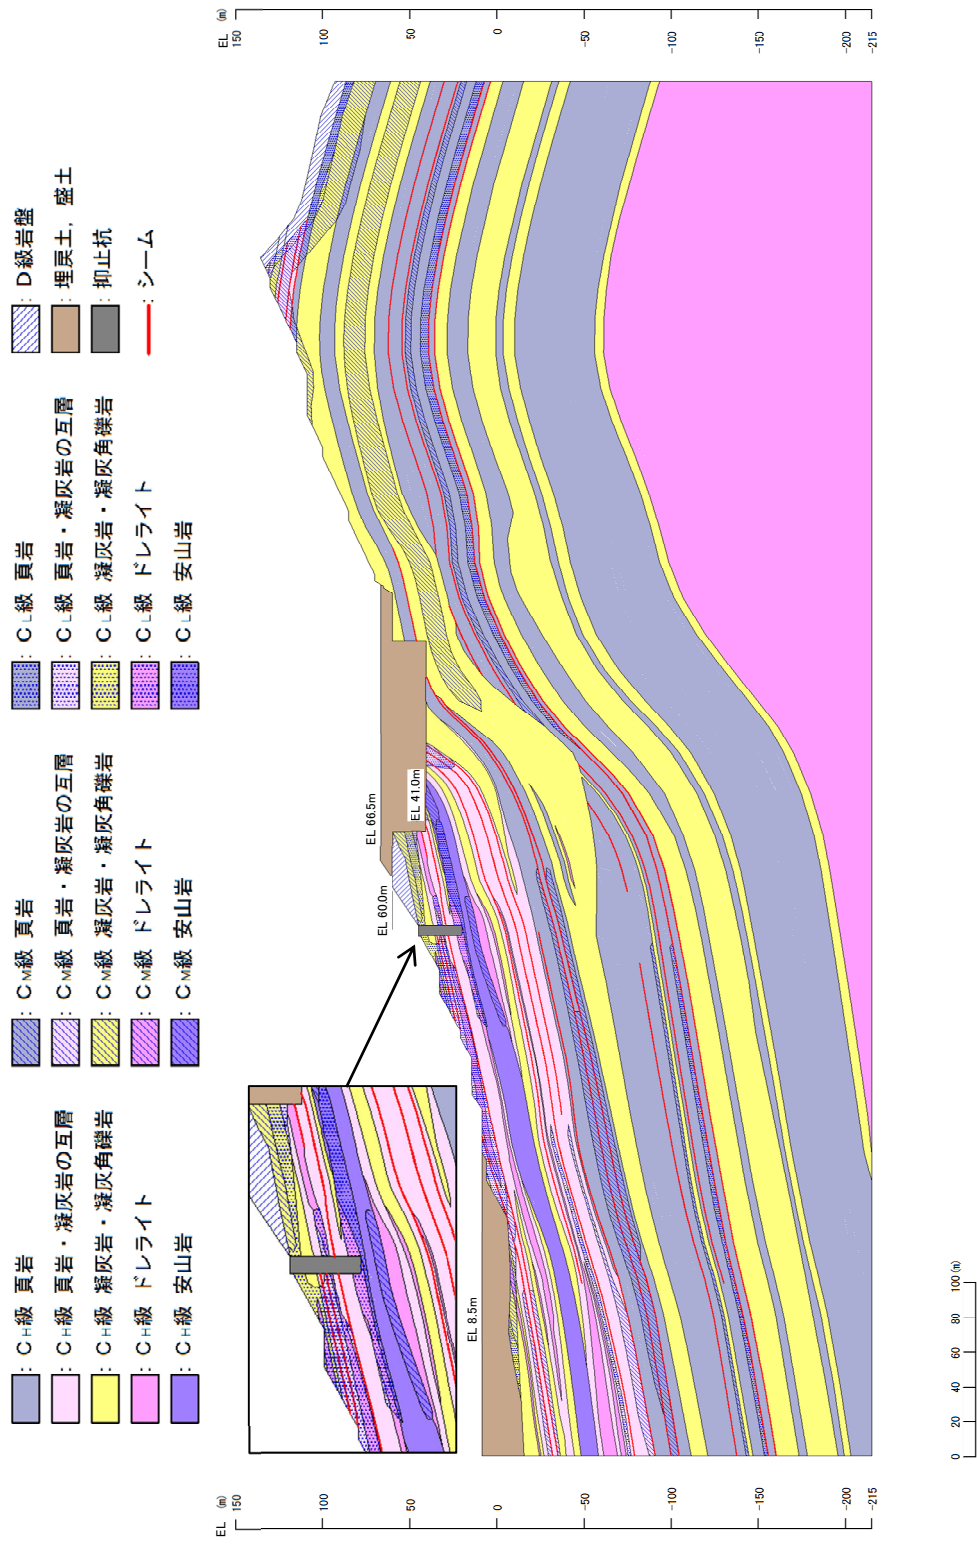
②-②' 断面 解析用岩盤分類図
